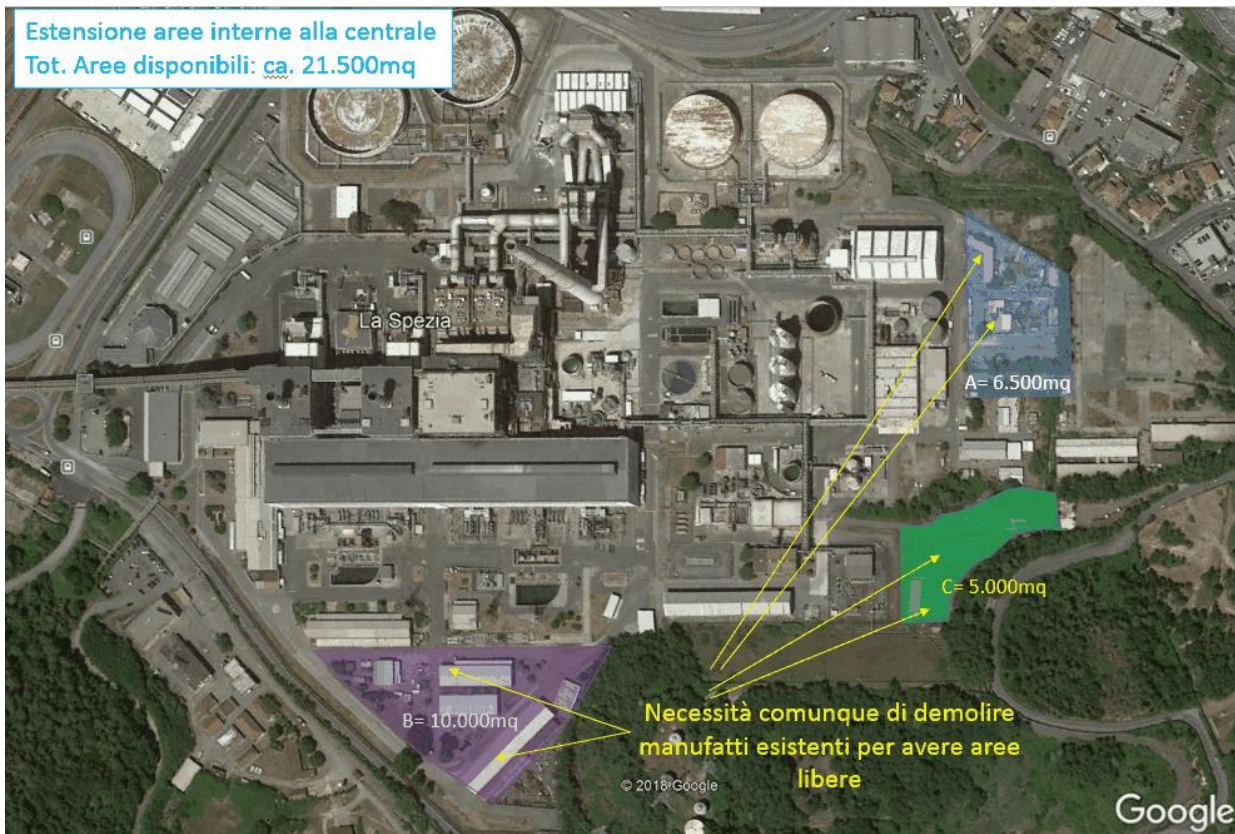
Rappresentazione delle aree di cantiere previste interne alla centrale
